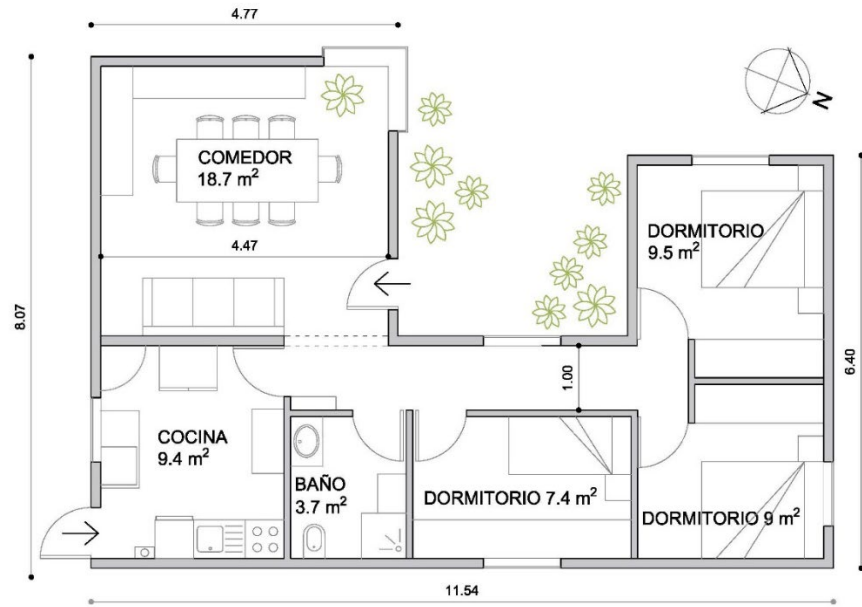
Planta general de la vivienda actual, 71,5 m². Elaboración propia.
